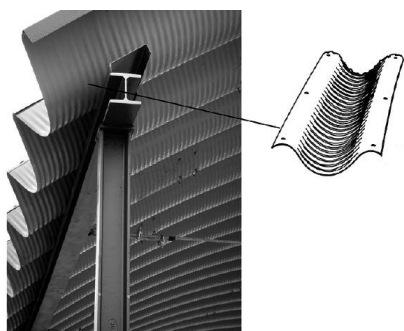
Montaż dachu łukowego w systemie TG [10]
